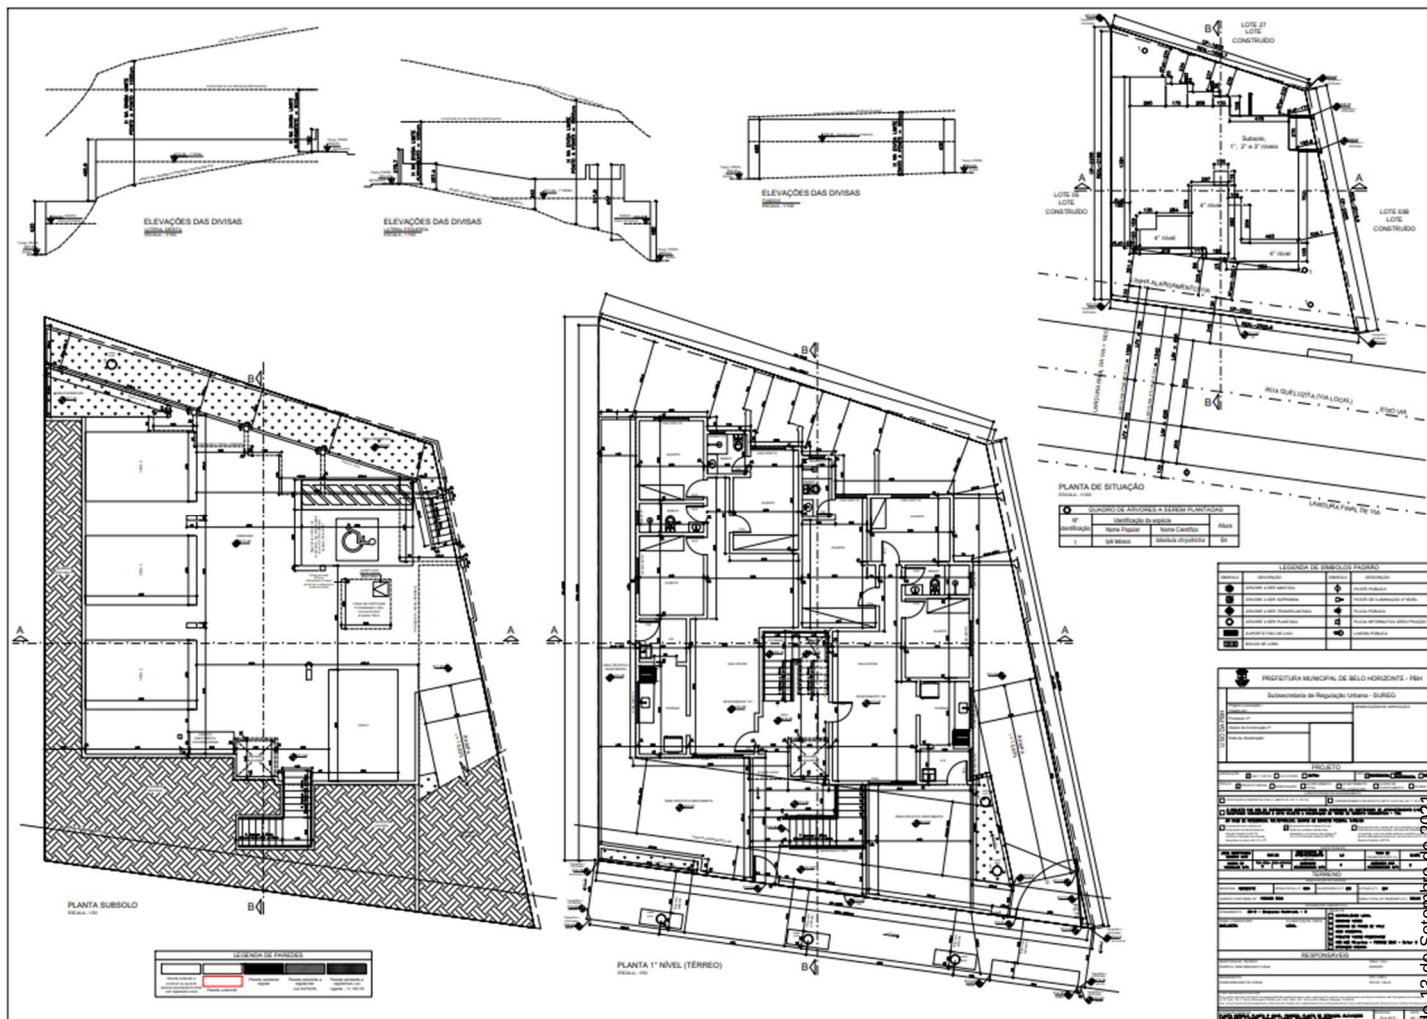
Planta baixa do empreendimento (Fonte: Empreendedor, 2025 arquivo Empreendimento Queluzita_PRANCHA 01- 02_06-2025.pdf)
